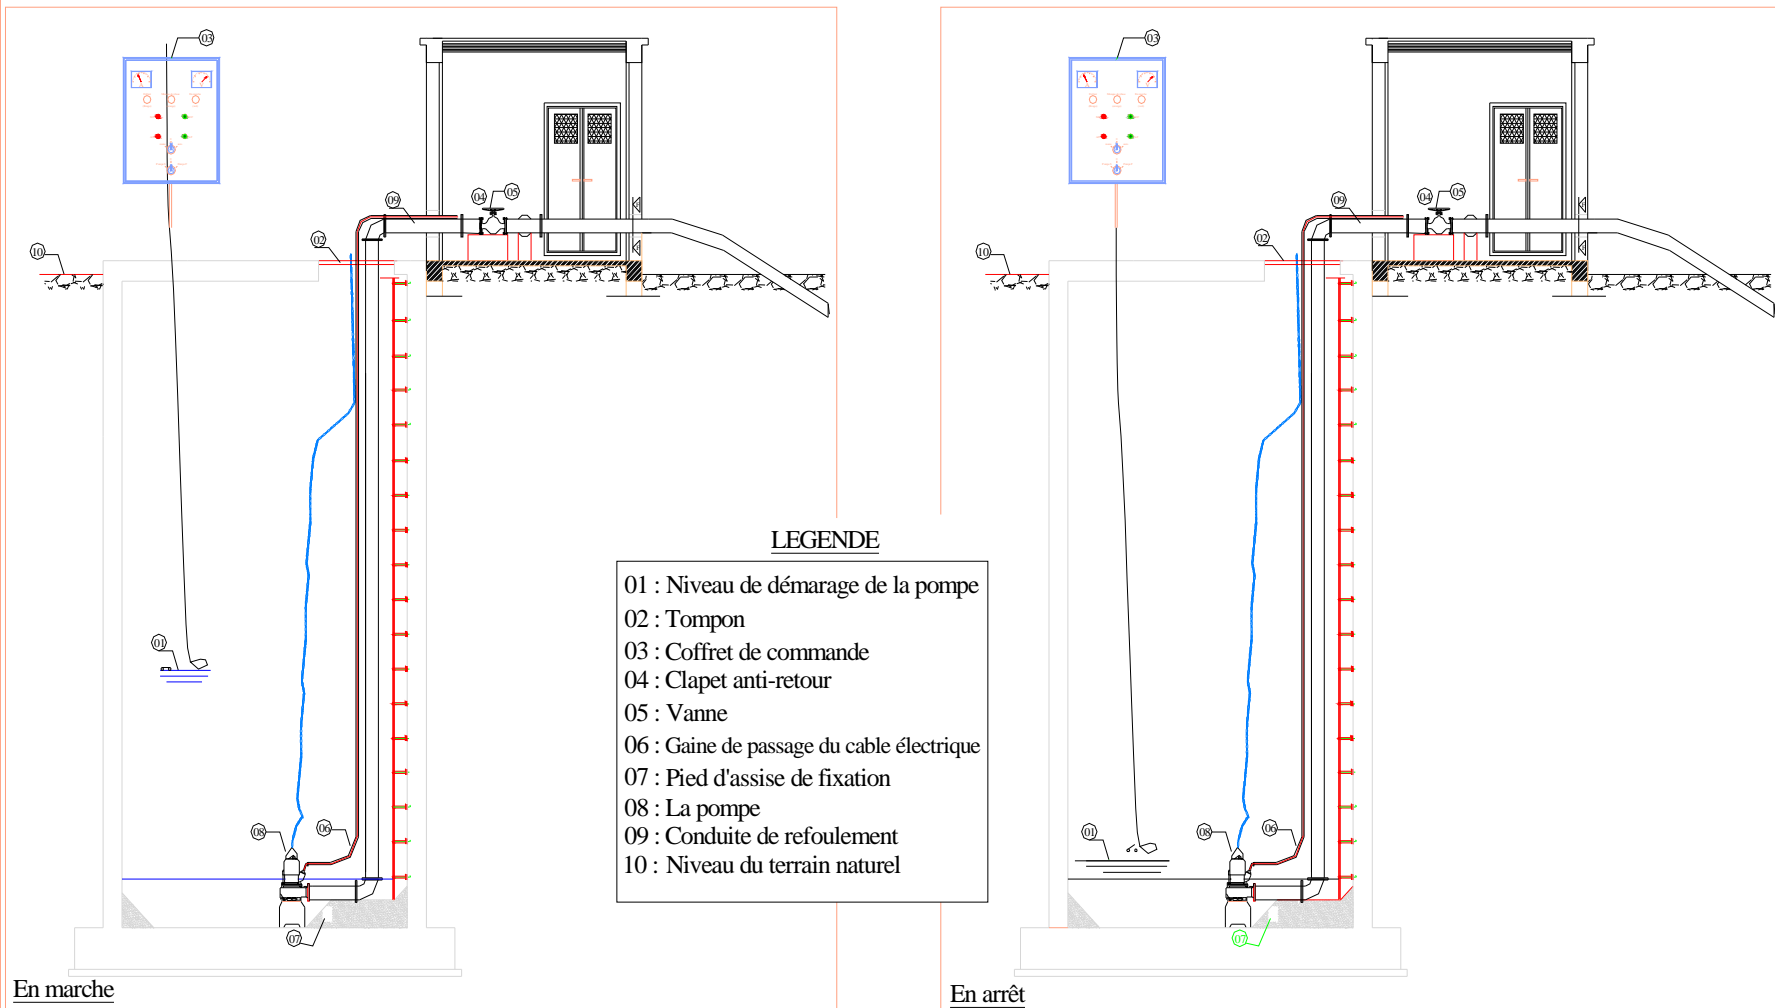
Schéma de la démarage des pompes de la station de relevage
